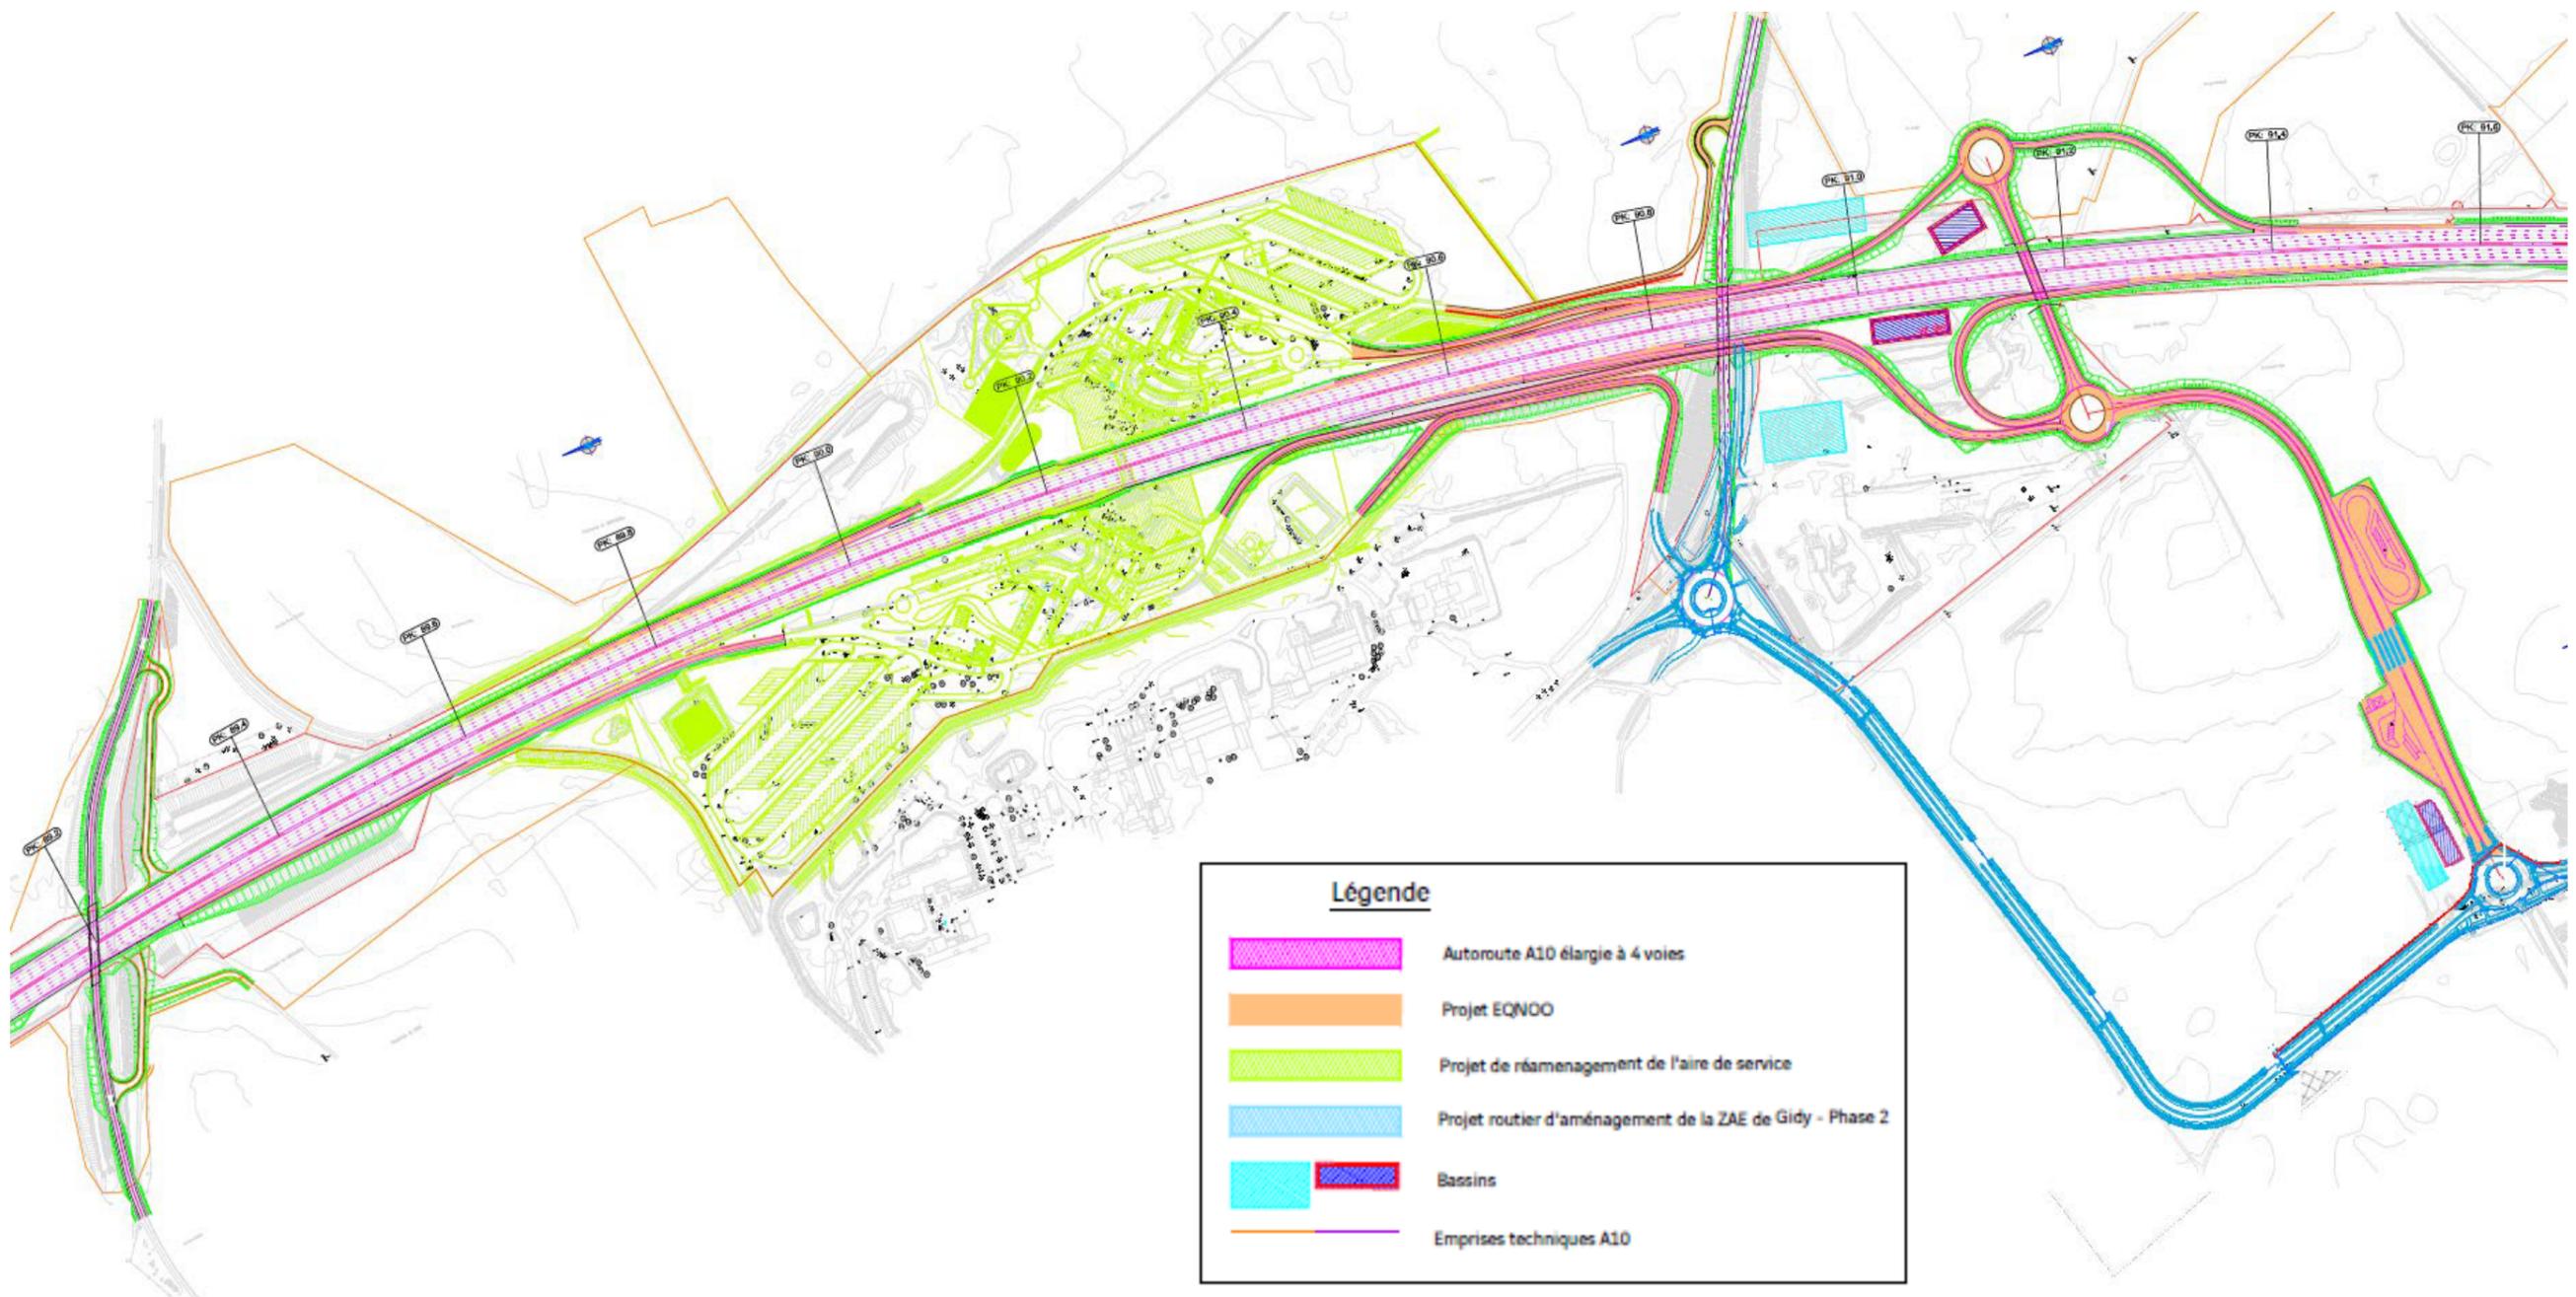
Vue en plan générale de la solution couplage mixte – sud RD702 (source : Dossier de Demande de Principe, EGIS 2018)
